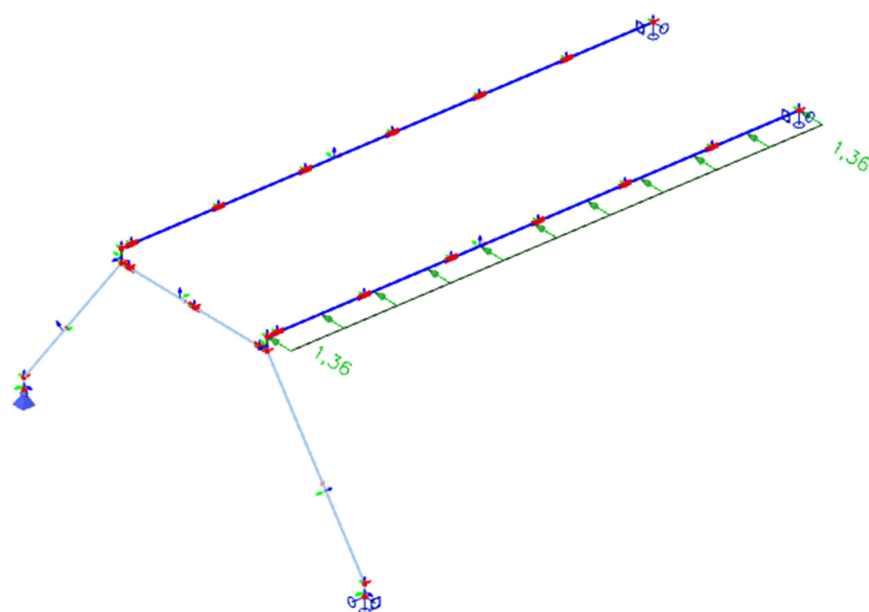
Konstrukce 1a, Zatěžovací stav ZS5
